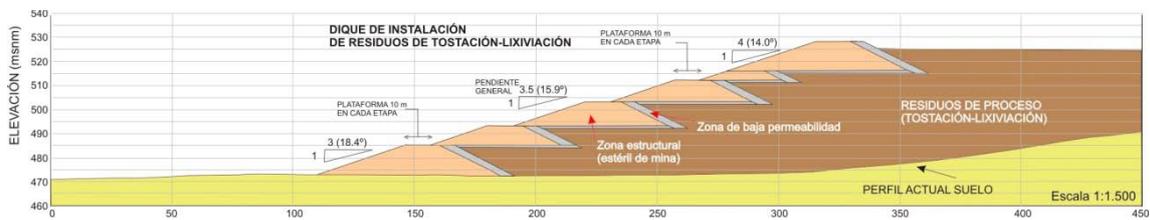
Sección constructiva tipo de instalación de estériles de proceso.
